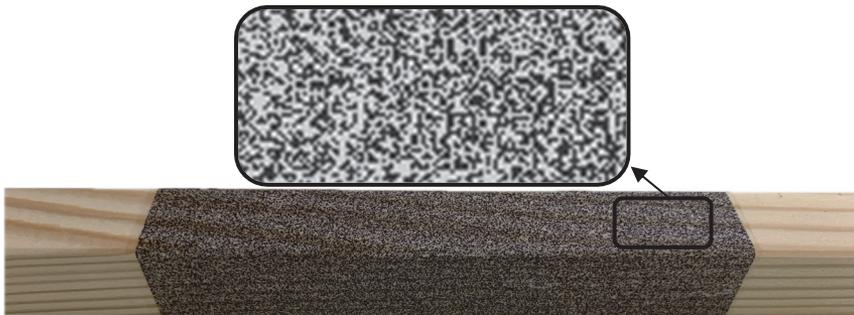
Speckle-Muster mit Tattoo-Folie auf einer Holzprobe
